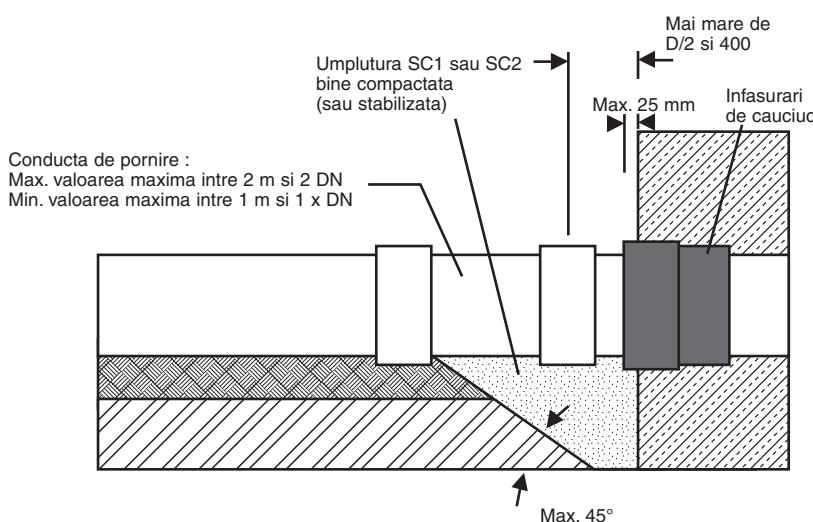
conectare alternativa - infasurare de cauciuc inglobata in beton
